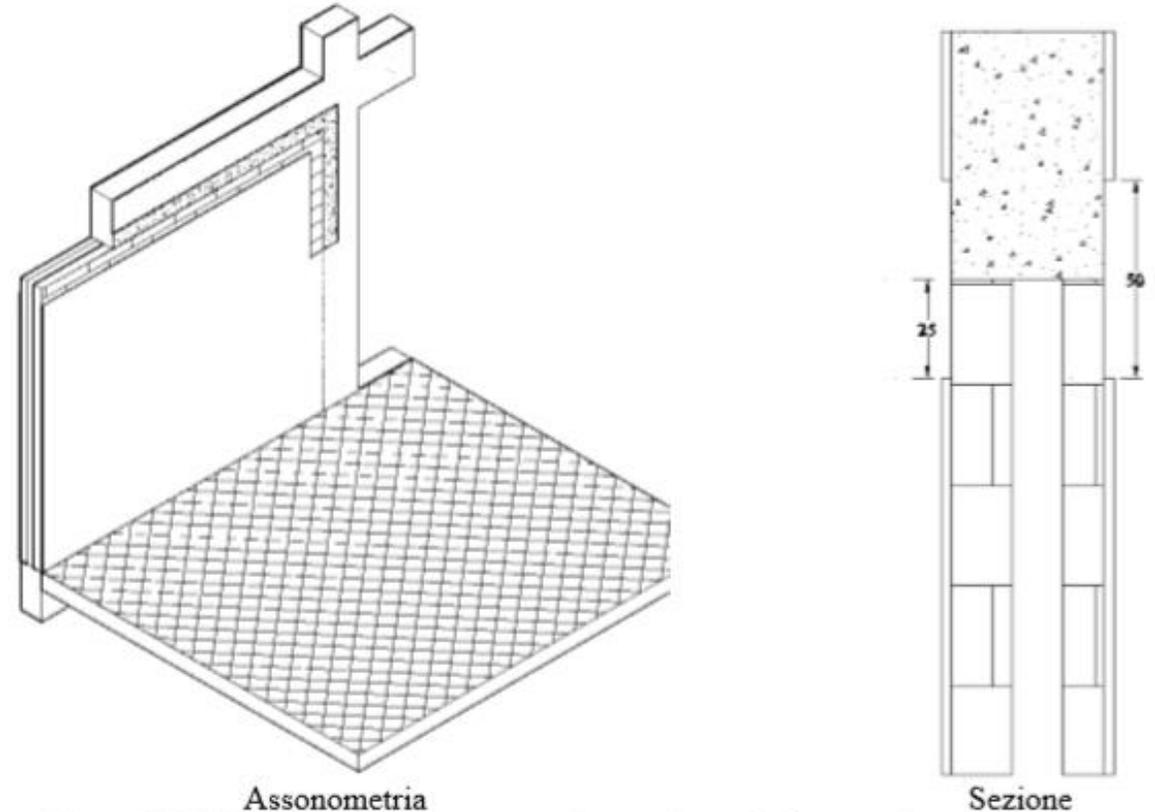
Rimozione dell'intonaco esistente lungo le fasce perimetrali di ancoraggio.
